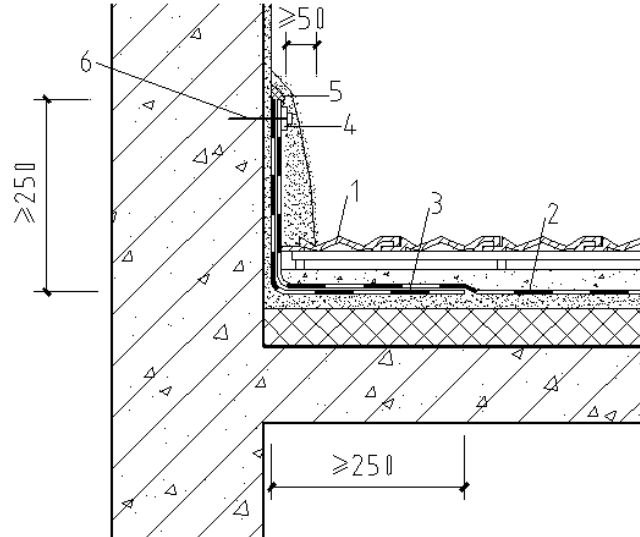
烧结瓦、混凝土瓦屋面山墙防水构造
